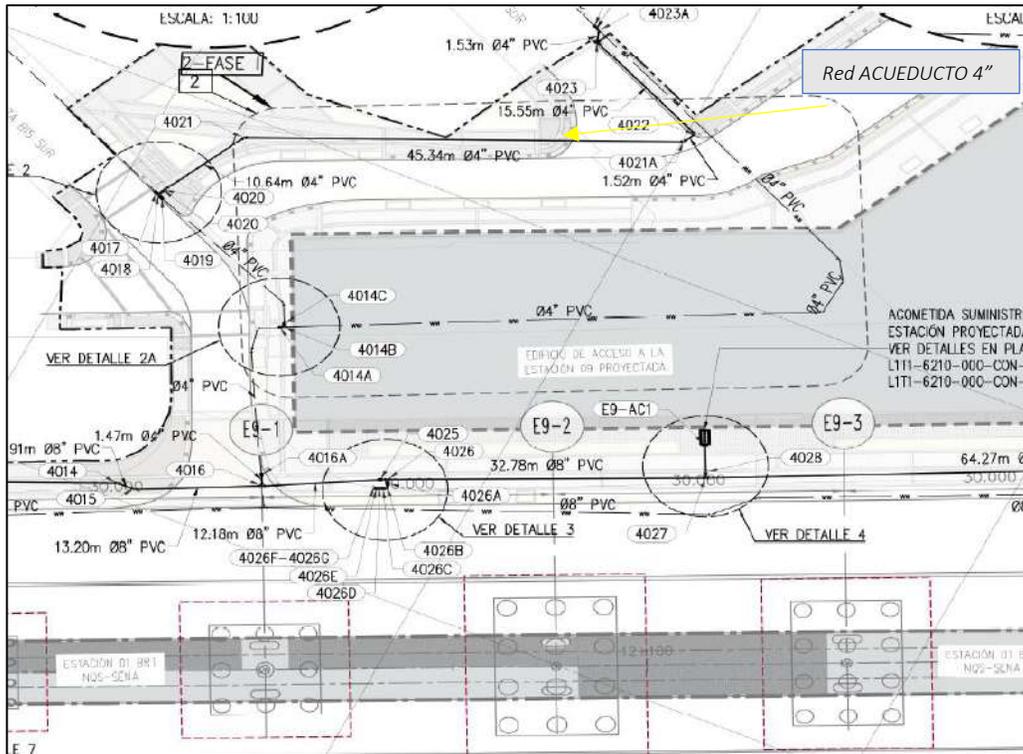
Plano de localización general de la red ACU 4-02
